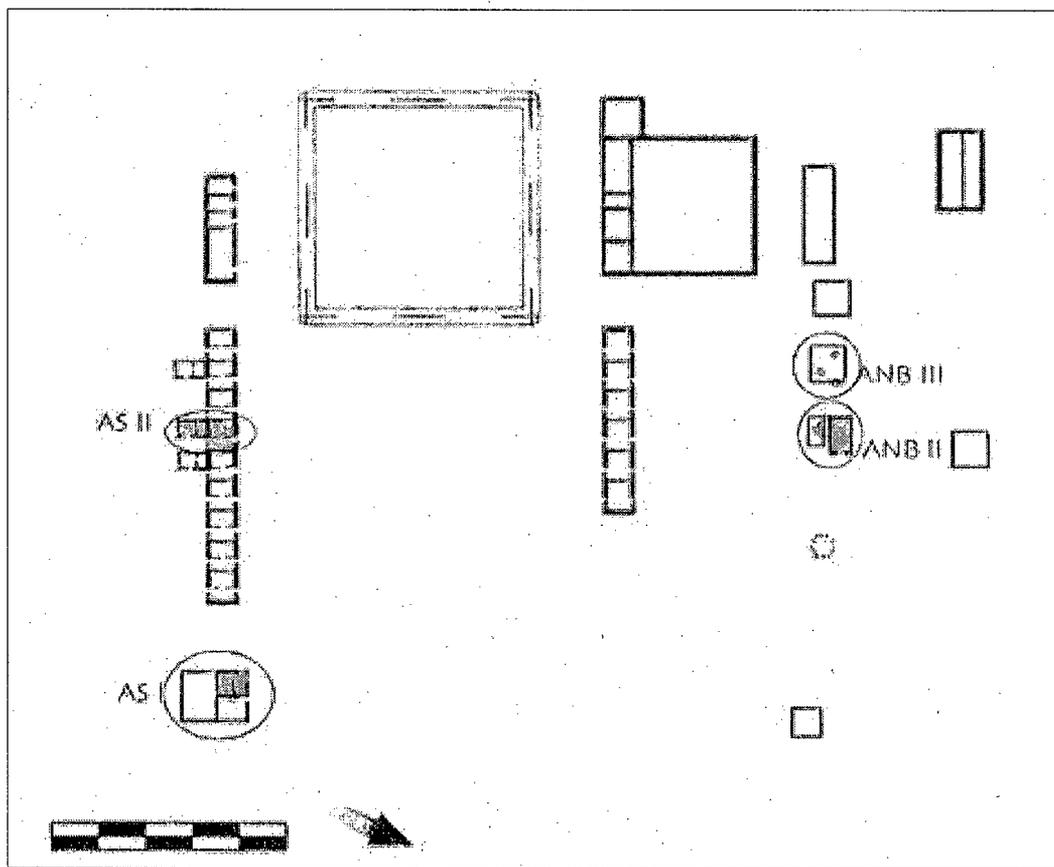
Plano de las estructuras seleccionadas para la comparación de las características arquitectónicas y constructivas.
